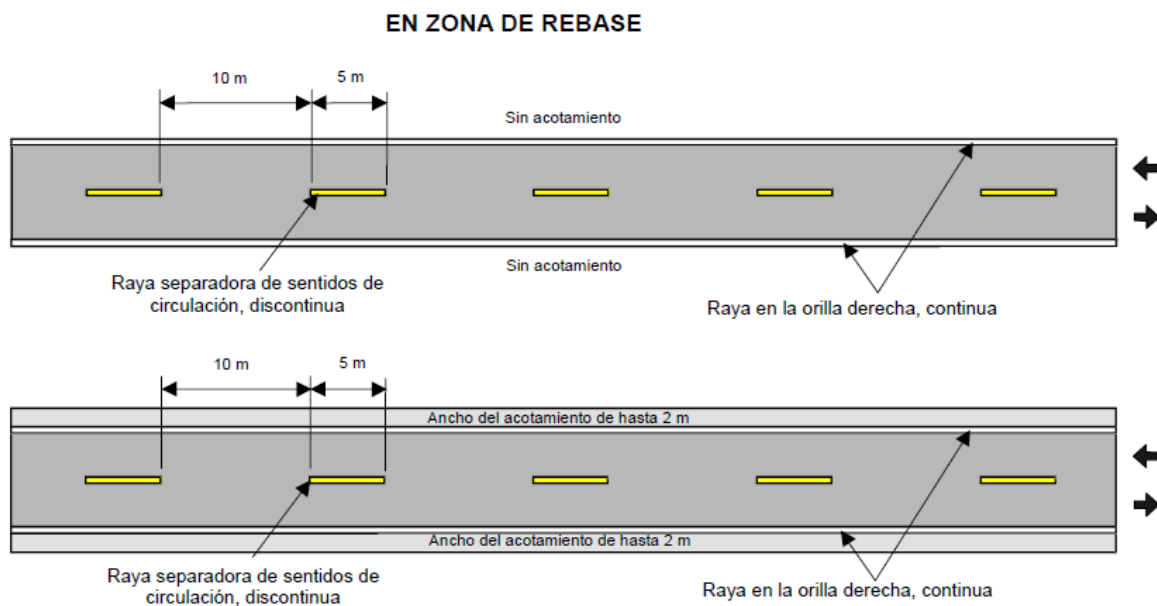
Marcas en el pavimento en carreteras con ancho de arroyo vial de hasta 6,5 m
